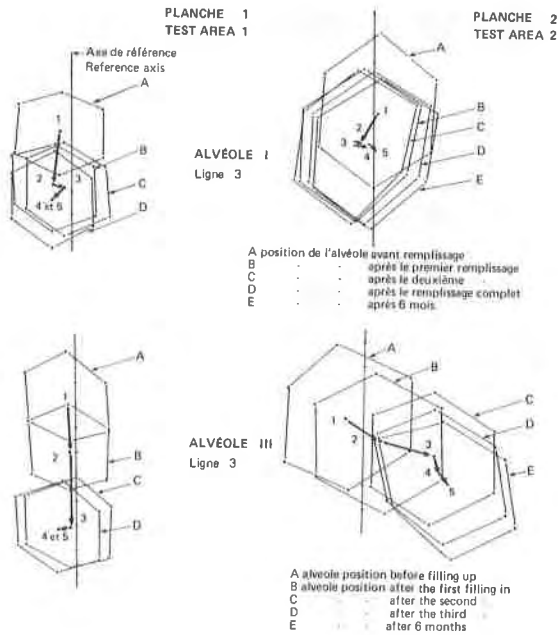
Schémas comparatifs de déformation des alvéoles sur les deux planches d'essai
